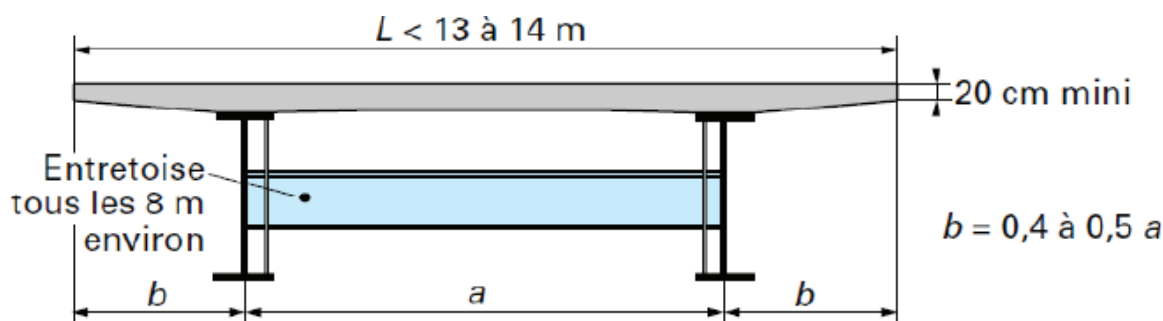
Schéma d'un bipoutre à entretoise. .
